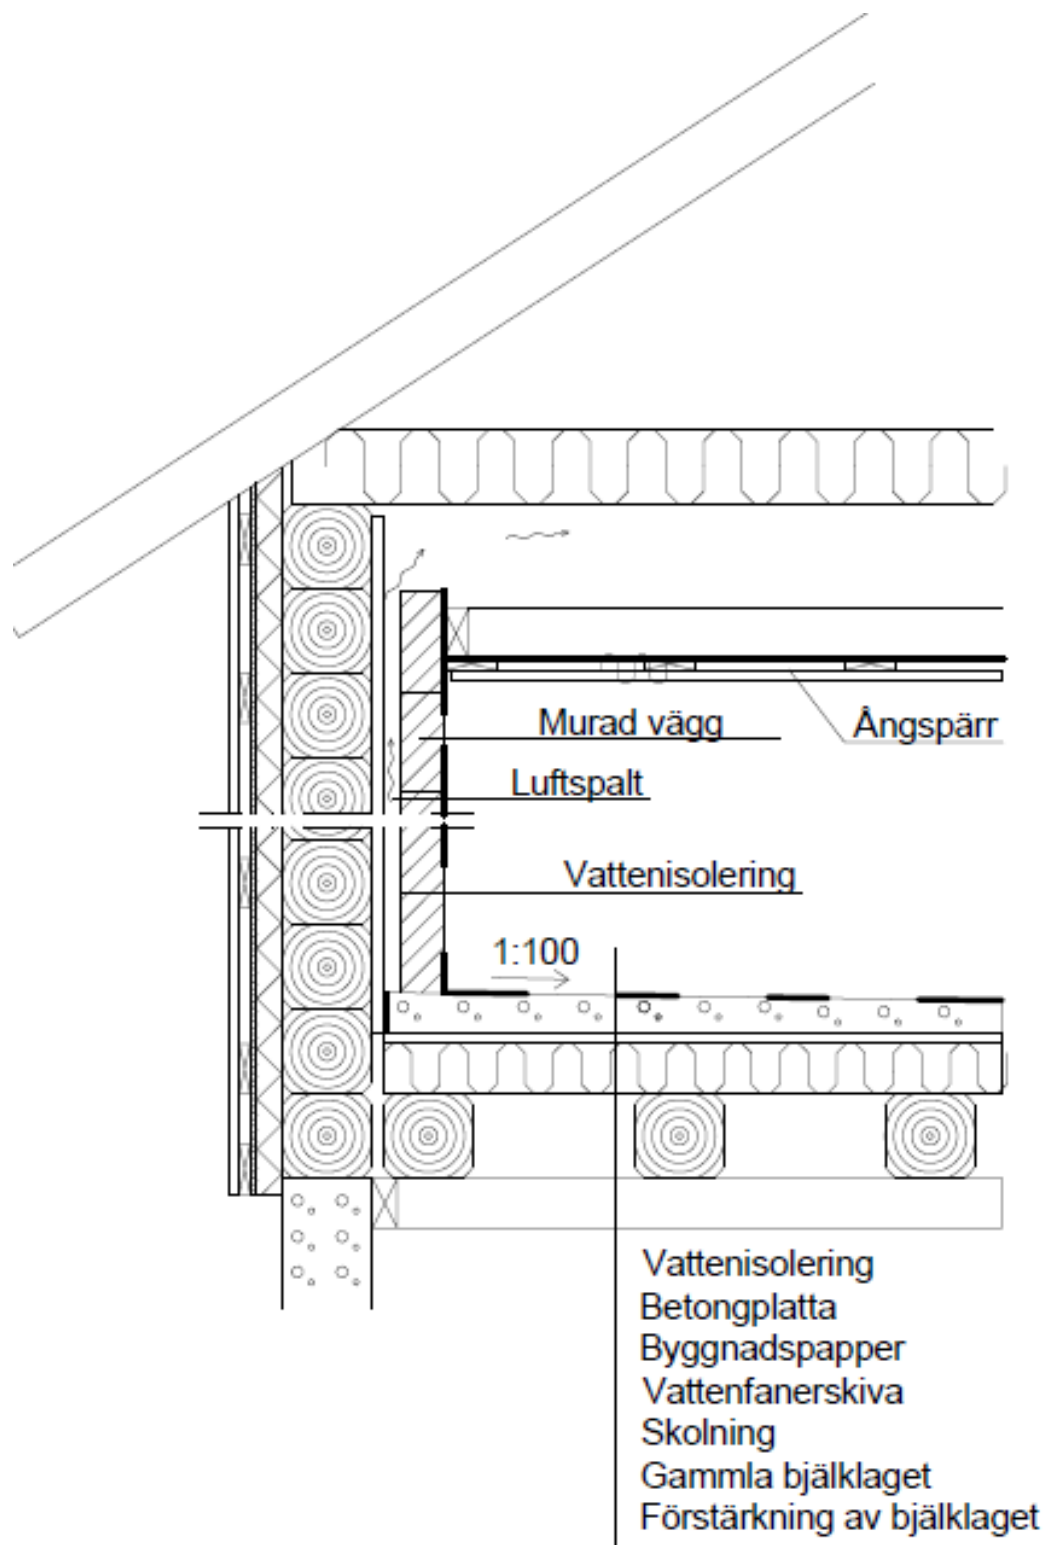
Skärningsritning på våtutrymme byggt på gammalt trä bjälklag med gjuten betongplatta och murad vägg.
